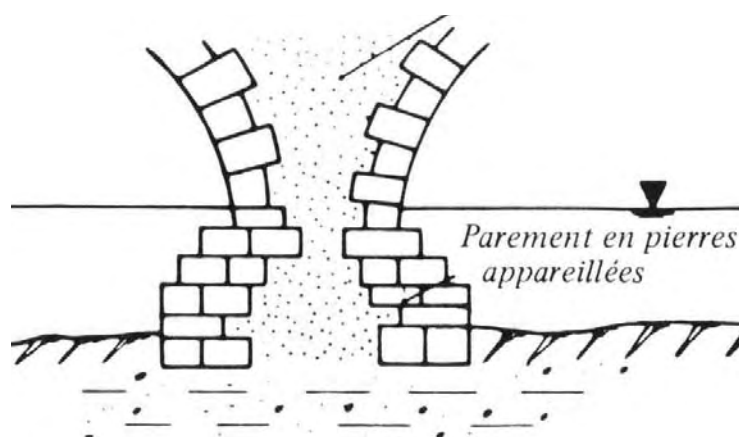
Cimentación superficial por medio de zapata de sillería con relleno de mampuesto rígido
